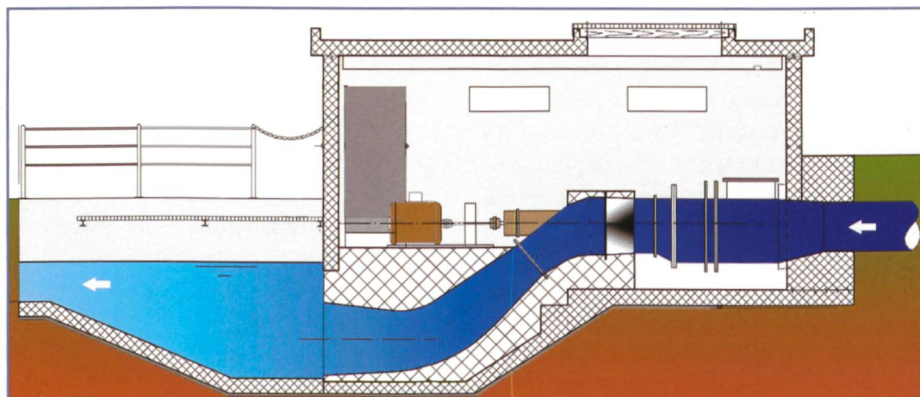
Der Planungsentwurf für die Ausbaustufe III beim Mühlbach in Malans schlägt ein Kleinwasserkraftwerk mit einer Rohrturbine vor.
